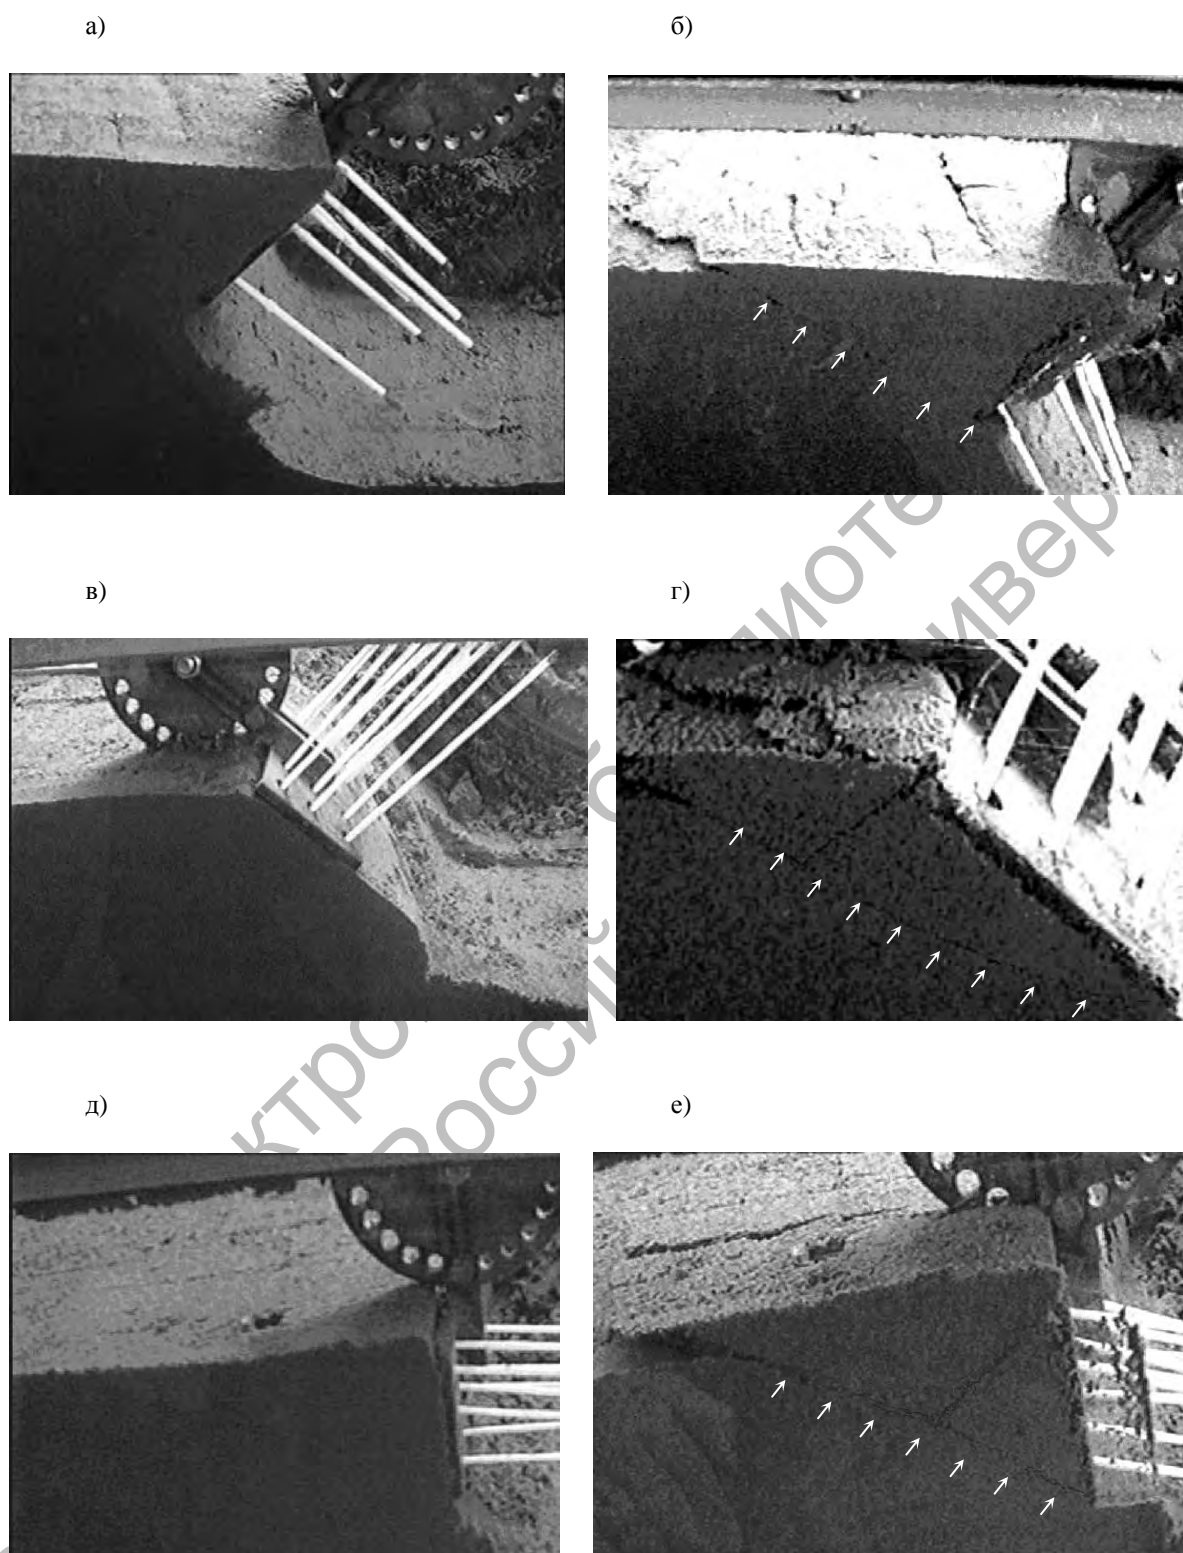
Положение площадок скольжения и флюгеров на подпорной стенке: а, б – с малым углом наклона; в, г – с большим углом наклона; д, е – с промежуточным углом (а, в, д – до эксперимента; в, г, е – в момент разрушения грунта)
